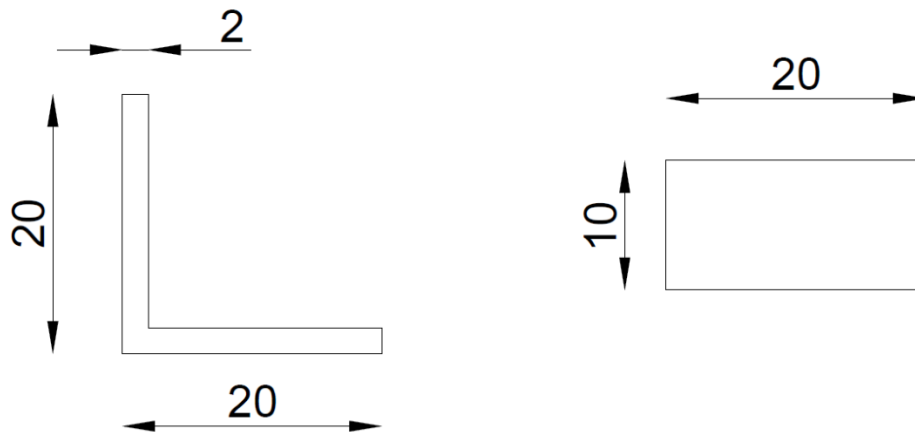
Vista de la sección de las columnas (izquierda) y las vigas (derecha). Las unidades están en milímetros.
